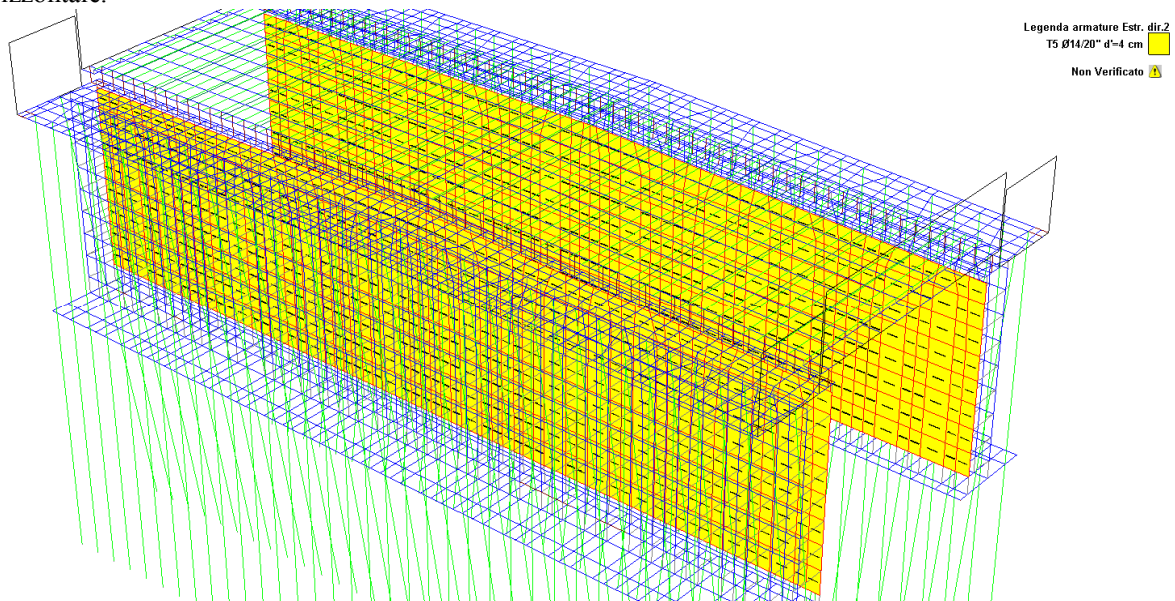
Armatura fusto Spalla di Estradosso ed Intradosso direzione 2
